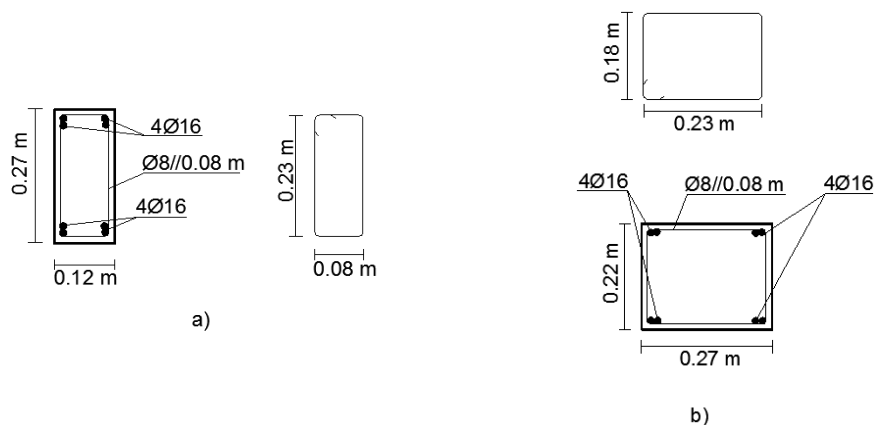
Corte transversal da peça P5, a) na viga e b) no pilar
